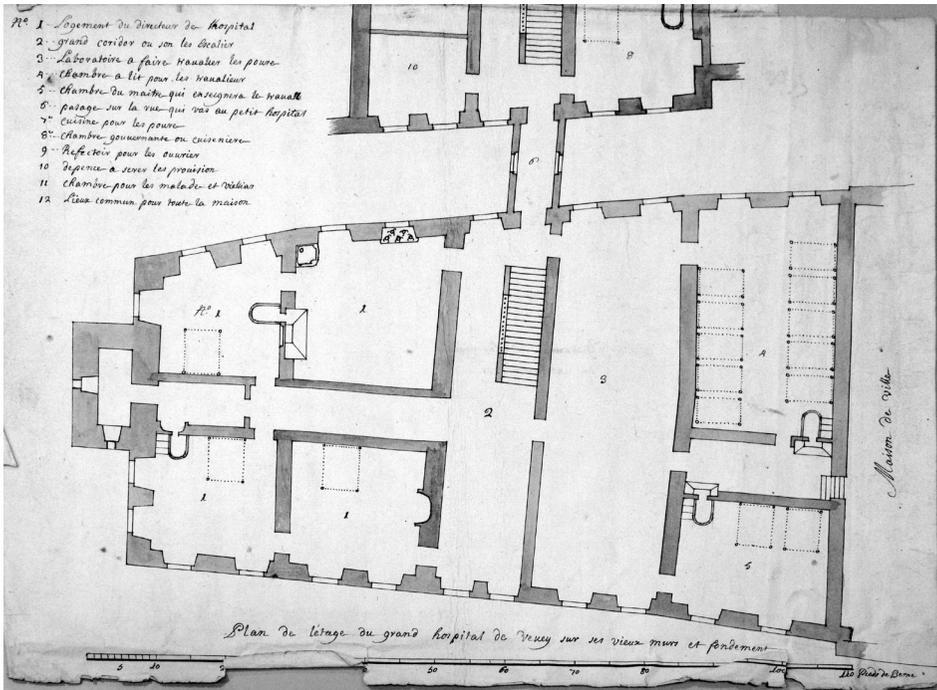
Vevey, hôpital, projet de Guillaume Delagrangé, détail du plan du rez-de-chaussée, 1732 (AC Vevey).
